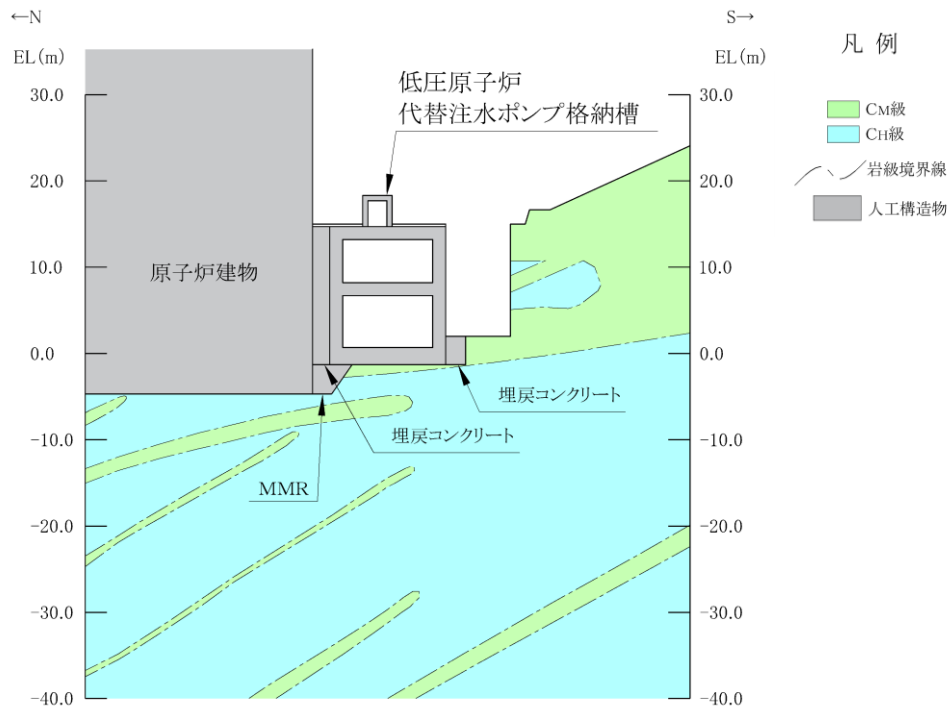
低圧原子炉代替注水ポンプ格納槽 評価対象断面図 (A-A断面位置)
